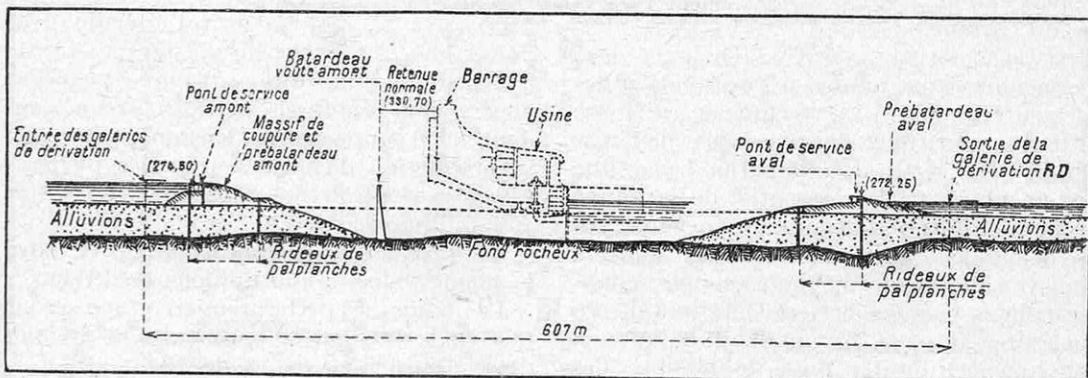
COUPE LONGITUDINALE DU SITE DE GÉNISSIAT
